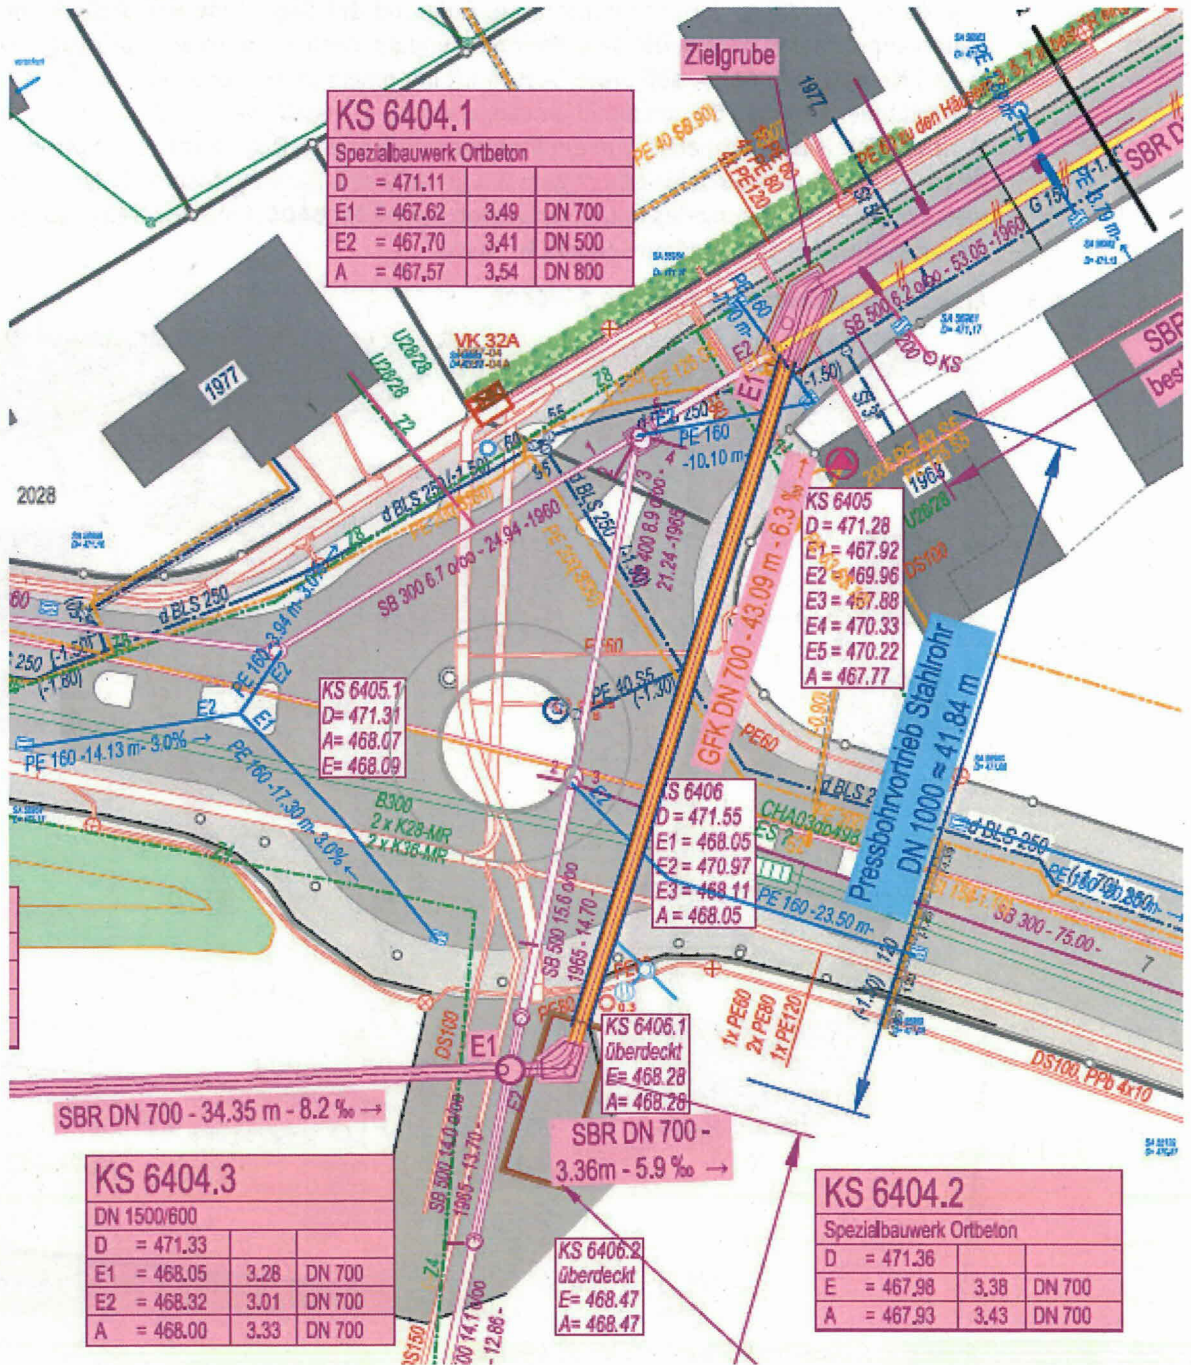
Ausschnitt Situationsplan Bauprojekt
